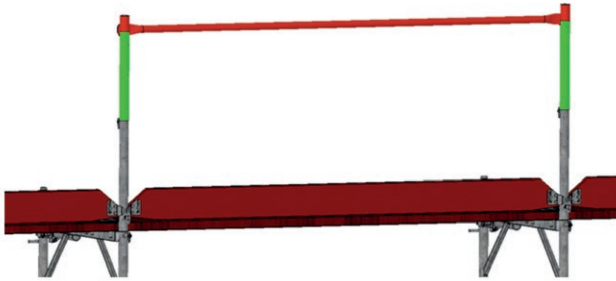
Empfohlene Anschlagpunkte beim oberen Gerüstabschluss
